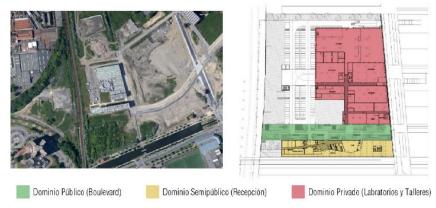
Emplazamiento y zonificación del proyecto en planta Fuente: http://www.archdaily.com (2023)
